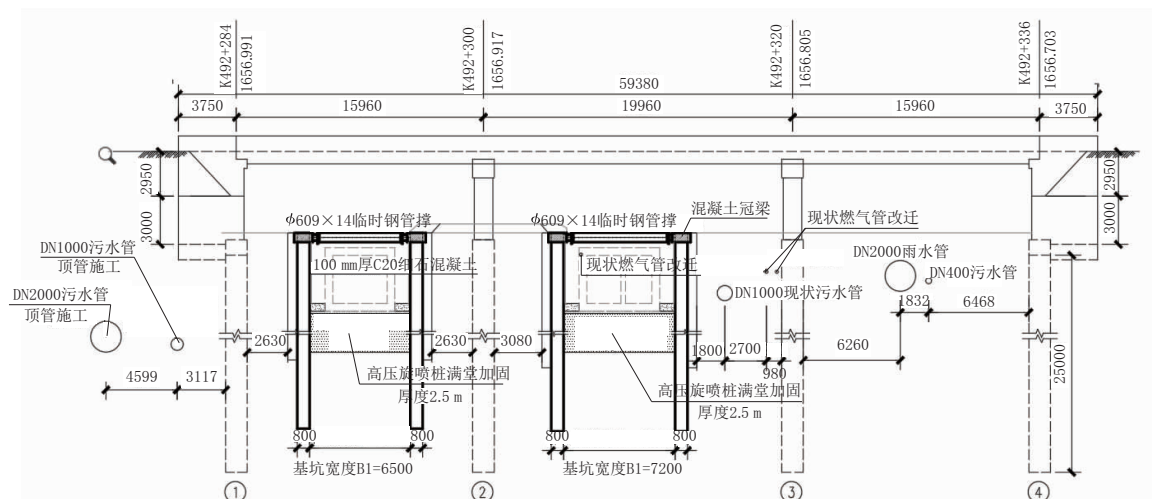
基坑、桥墩、管线相对位置关系图(单位:mm)
